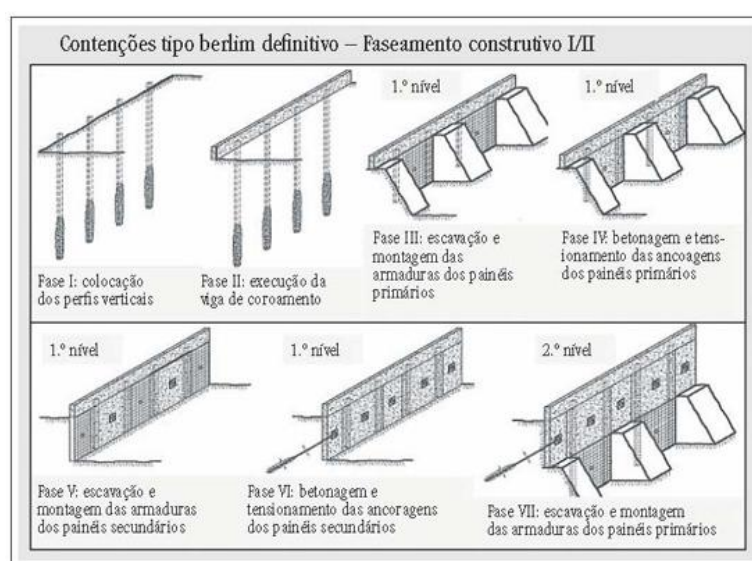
Contenção tipo Berlim definitivo (site: construironline, 2012).
